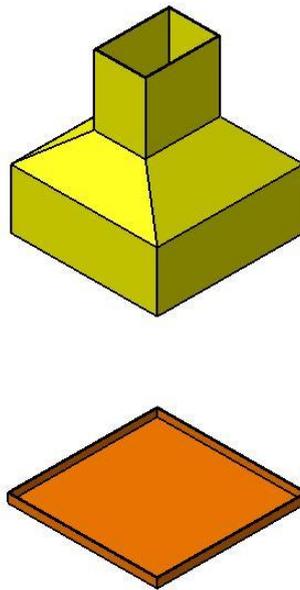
Vista Isométrica Explodida Fôrma Fiberglass
